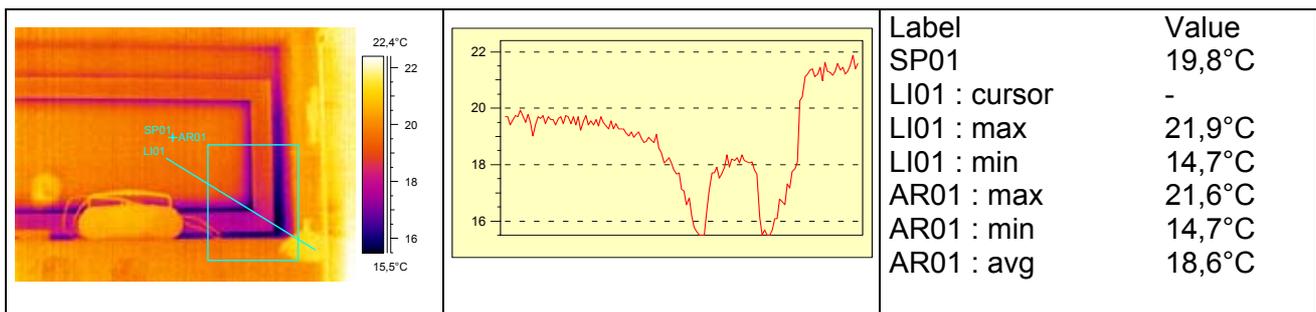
Innenaufnahme, Badezimmer-Fenster, Nordfassade, Obergeschoss:
